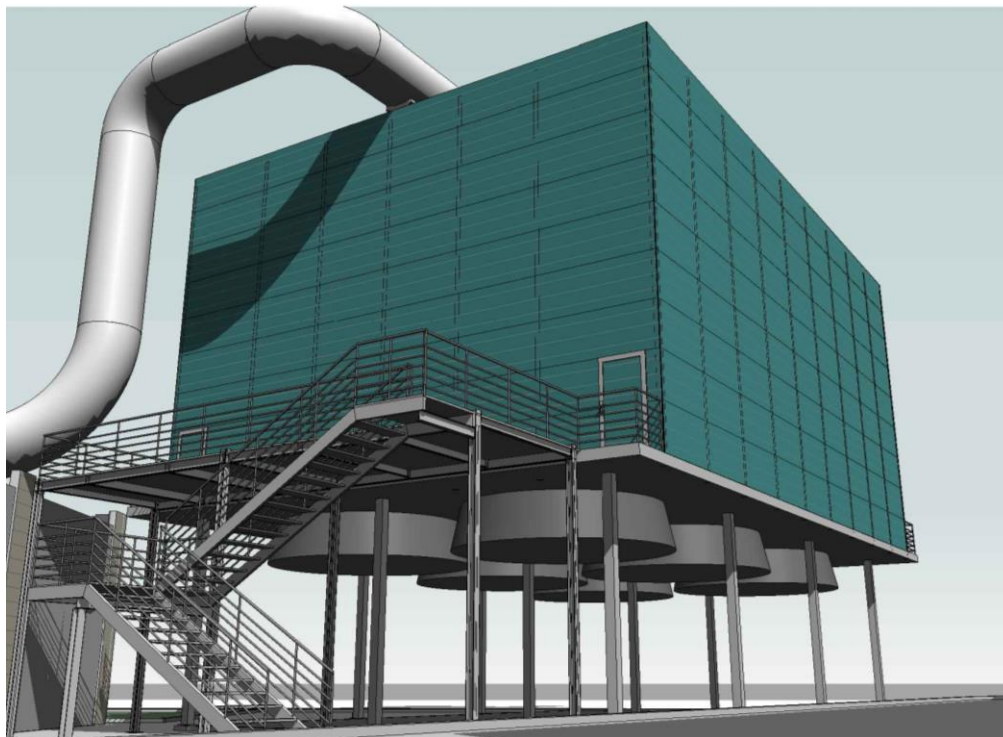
Edificio Fossa Scorie – vista prospettica esterno
